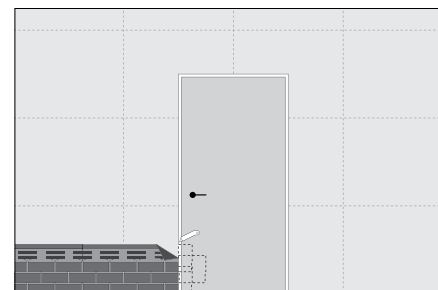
Монтаж фасадной плитки вокруг дверных проемов
